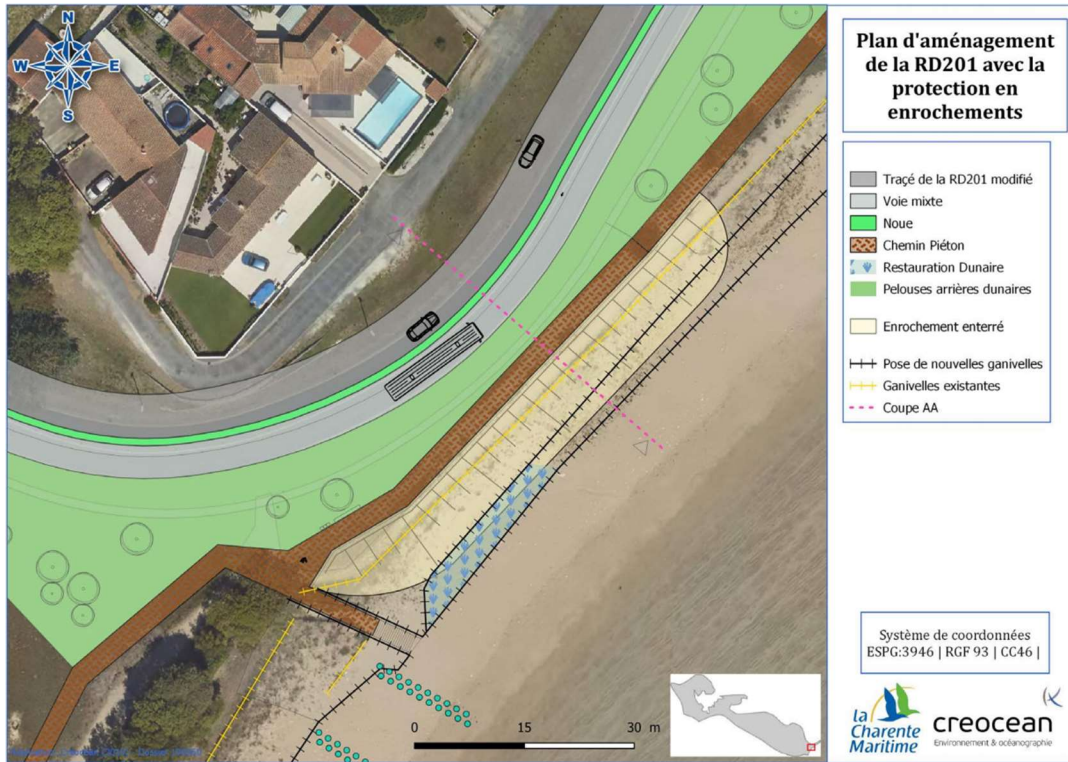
Plans d'aménagement de la RD 201 avec la protection en enrochements
